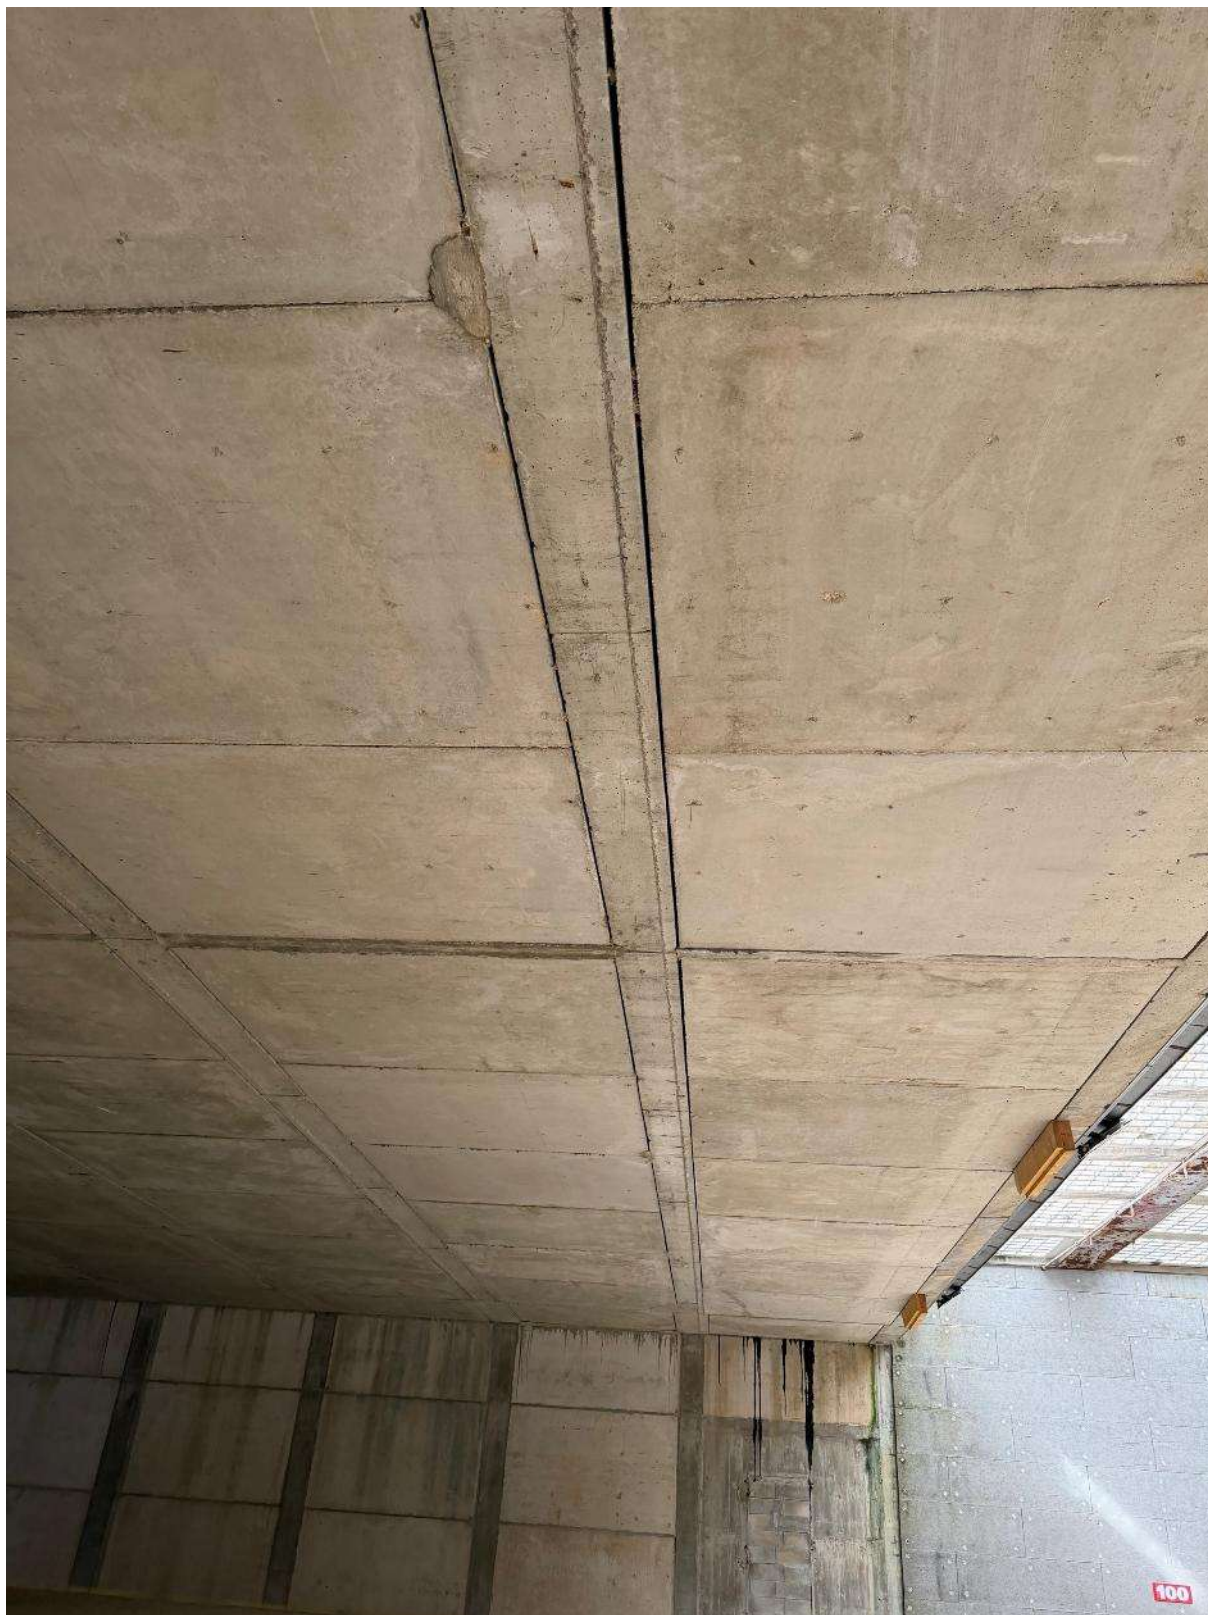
dans les zones en béton armé prédalle de 2.5m entre poutres sous tendues
